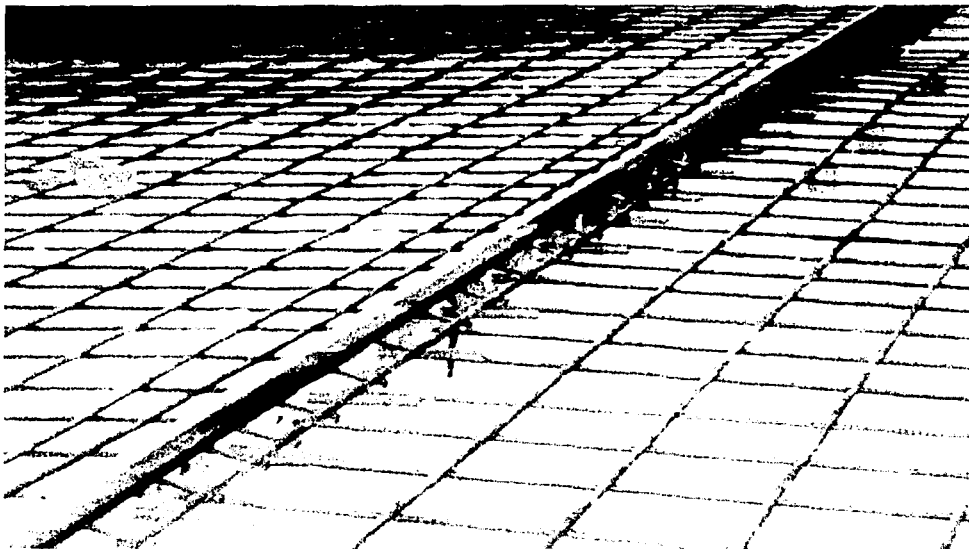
B-2 Armado y separación del acero de refuerzo y uso de pasajuntas en un piso industrial
